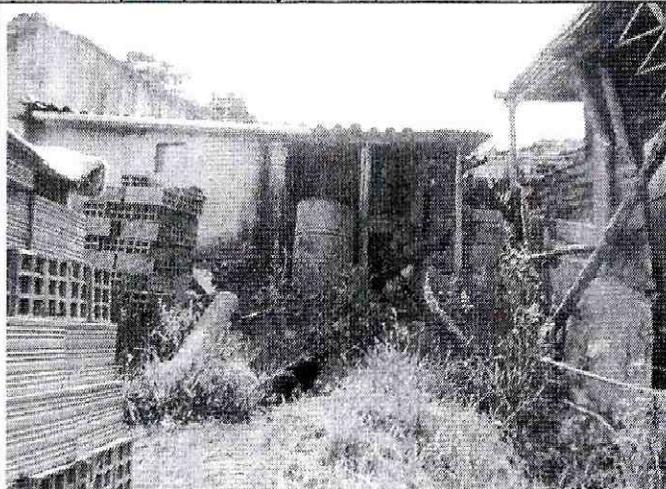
Vivienda de la Cra. 15 Bis E No 57-16 Sur emplaza en la parte alta del predio.
